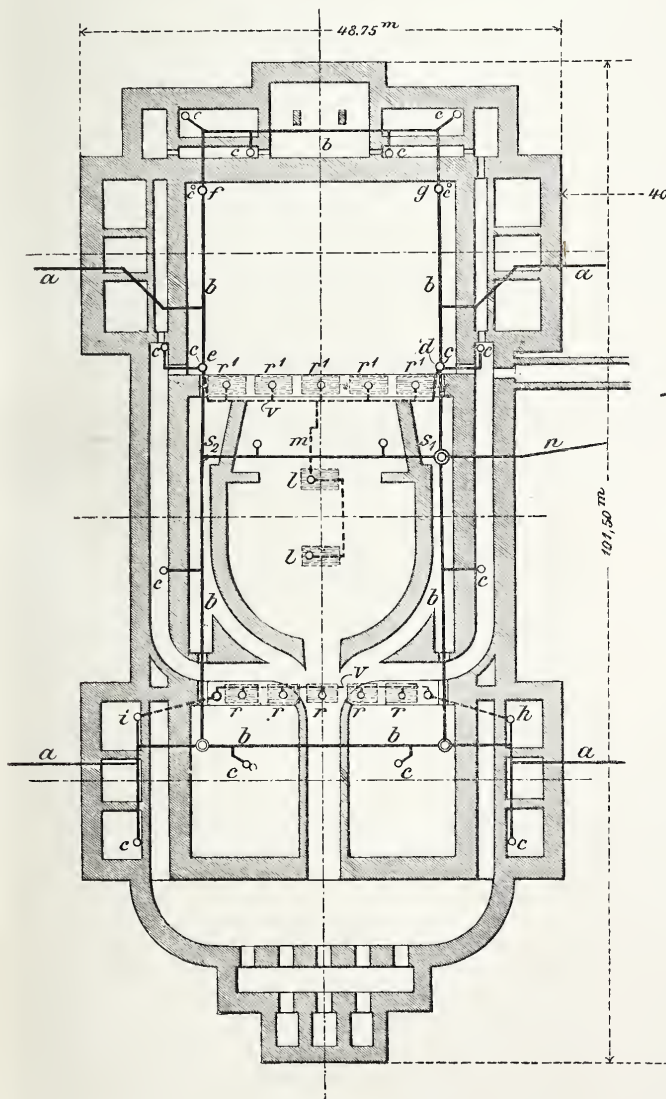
Grundriss vom Kellergeschoss des Opernhauses.
